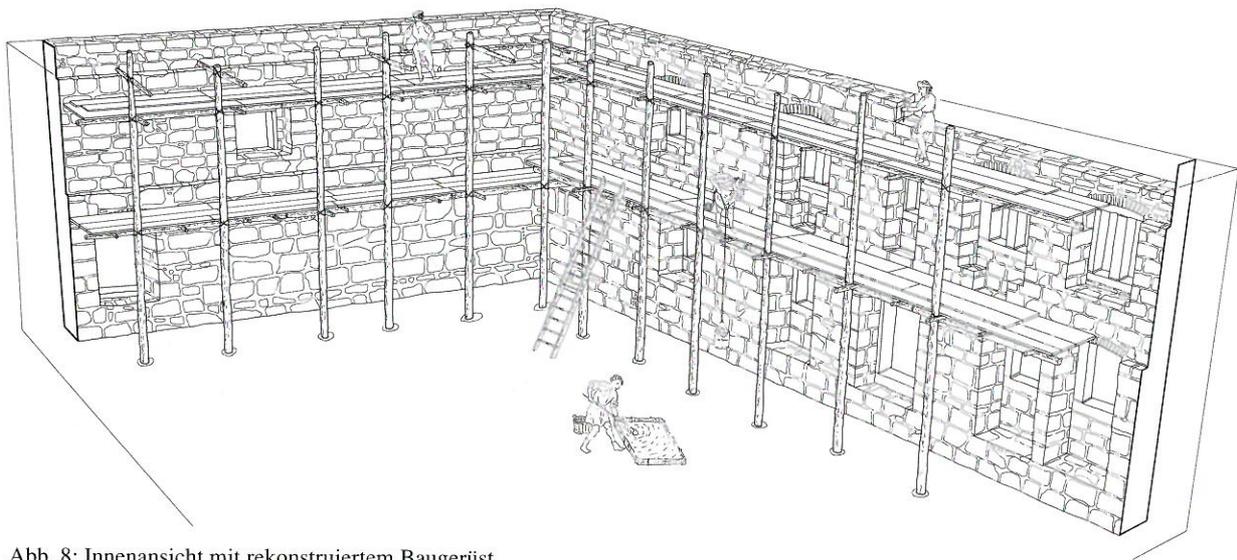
Innenansicht mit rekonstruiertem Baugerüst.
